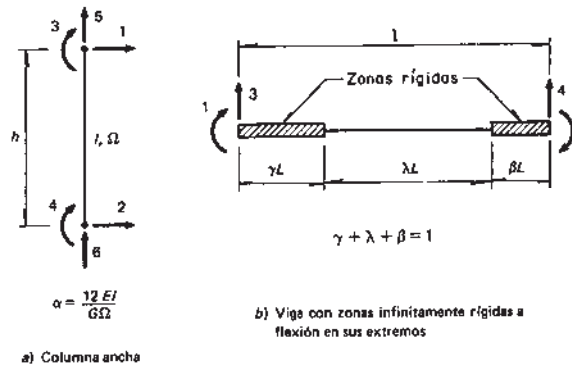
Grados de libertad para columnas y vigas en el método de la columna ancha
